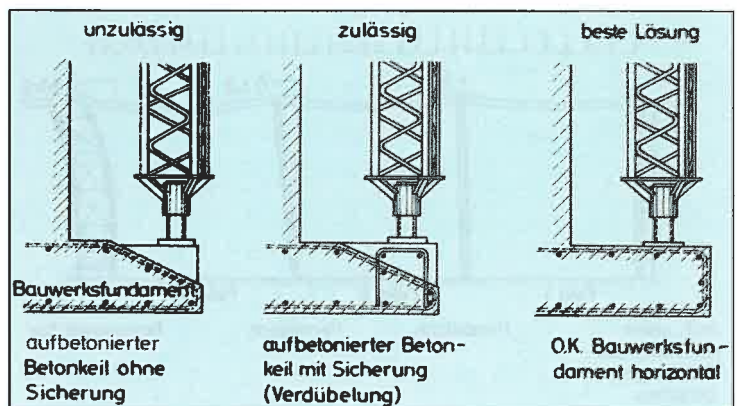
Maßnahmen an Bauwerksfundamenten zur Aufstellung von Gerüststützen
